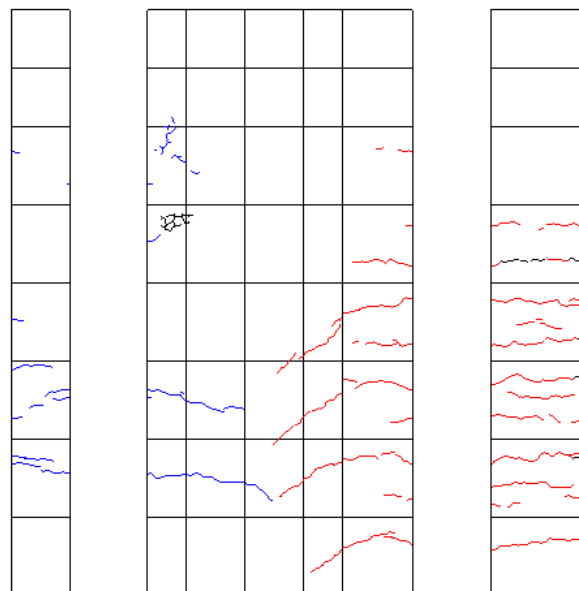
R=-1/400 ひび割れ図
